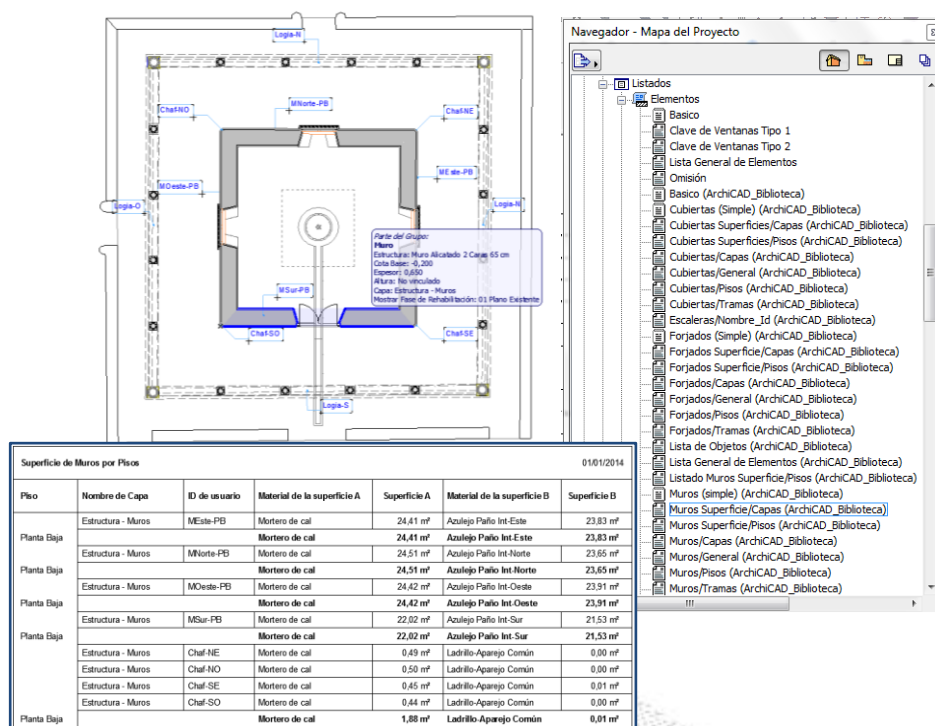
La ventana muestra el listado de Superficies de Muros en el piso Planta Baja del Cenador de Carlos V.
